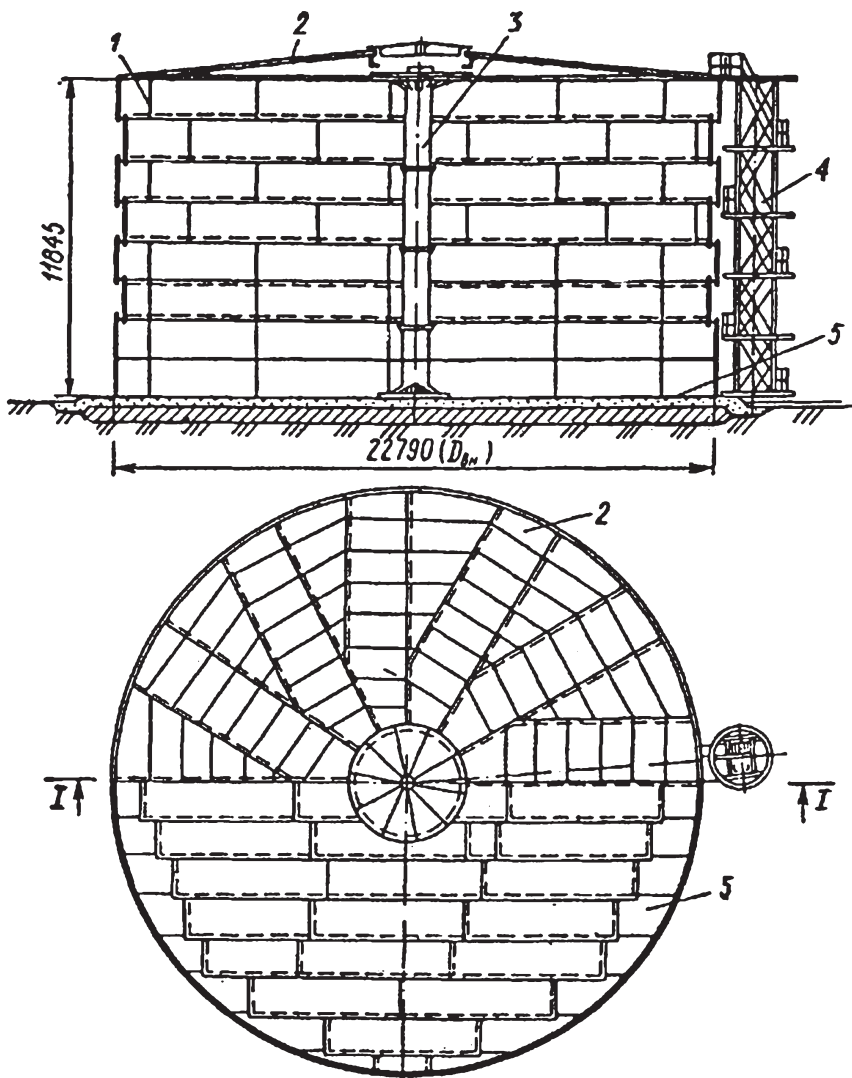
Вертикальный цилиндрический резервуар объемом 5000 м³ со щиповой кровлей:
